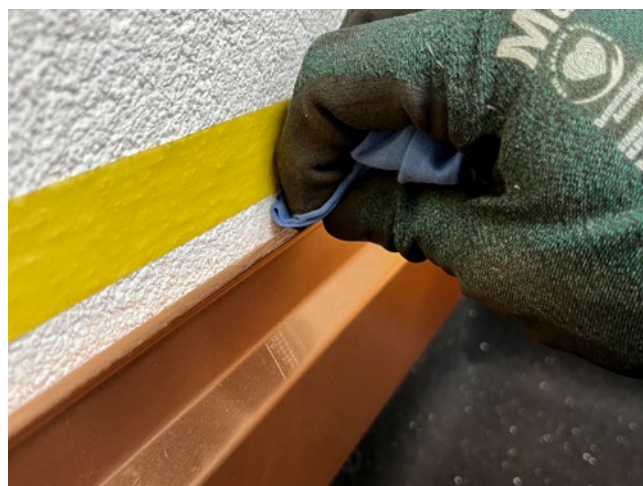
La lamiera di raccordo da impermeabilizzare viene fissata dopo aver applicato un nastro di separazione.
